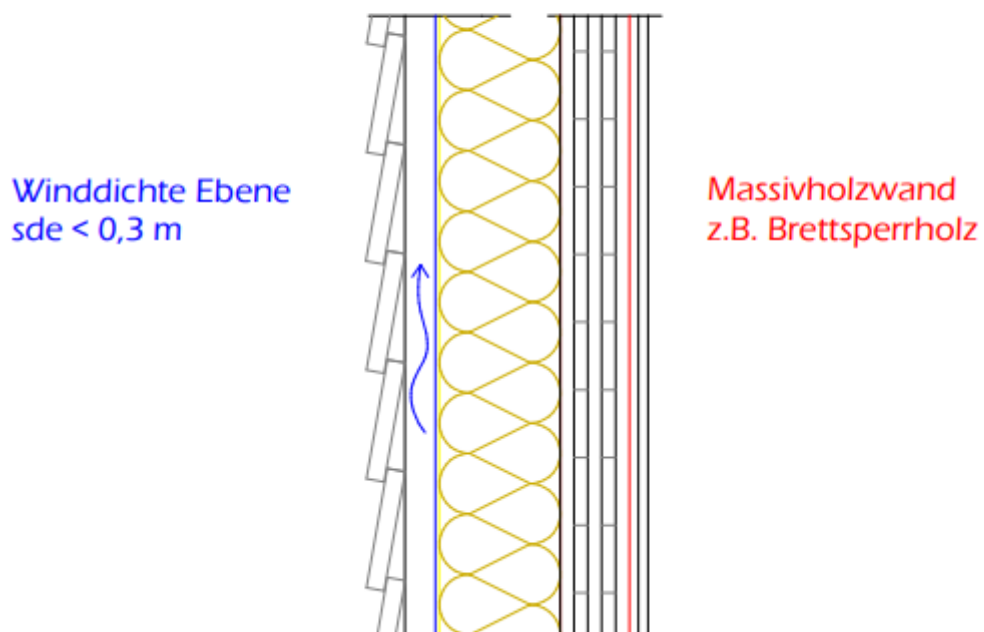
Holzmassiv-Außenwand mit hinterlüfteter Fassade
